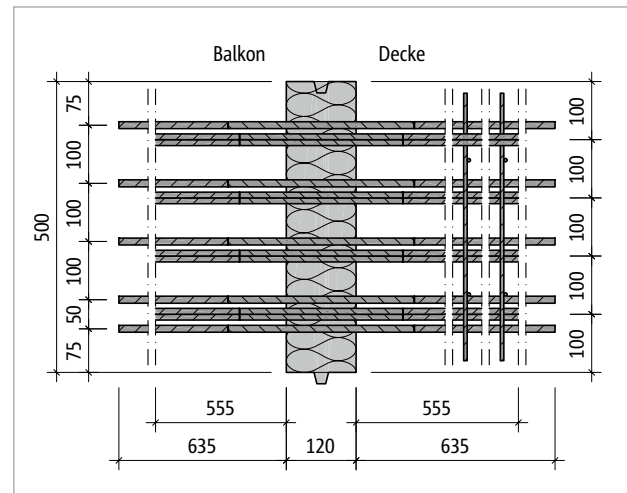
Schöck Isokorb® XT Typ DP-MM4-VV4: Grundriss
